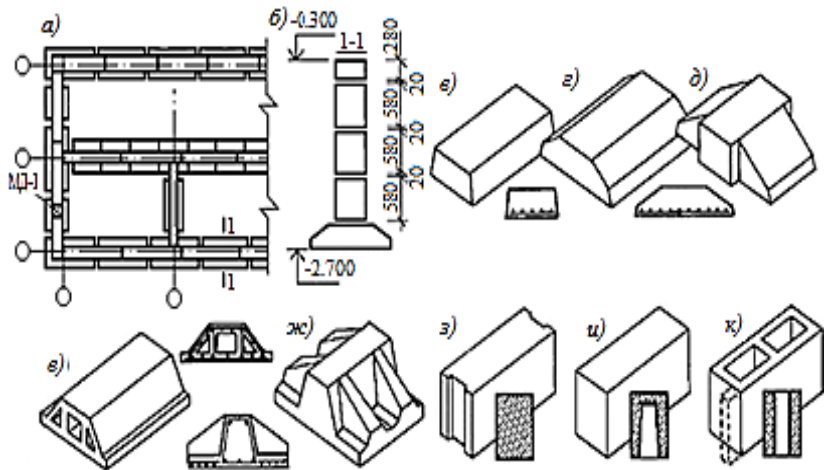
Елементи збірних стрічкових фундаментів: *а* – фрагмент плану фундаментів; *б* – переріз; *в-ж* – фундаментні плити (суцільні, пустотні, ребристі); *з-к* – фундаментні стінові блоки (суцільні, пустотні, дірчасті)
